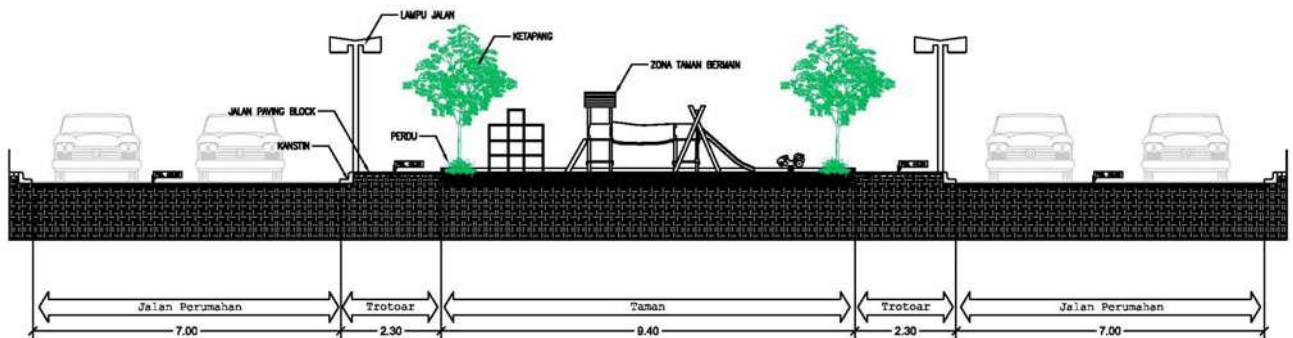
Site Plan Area Hijau 1 (*Scale to Fit*)
